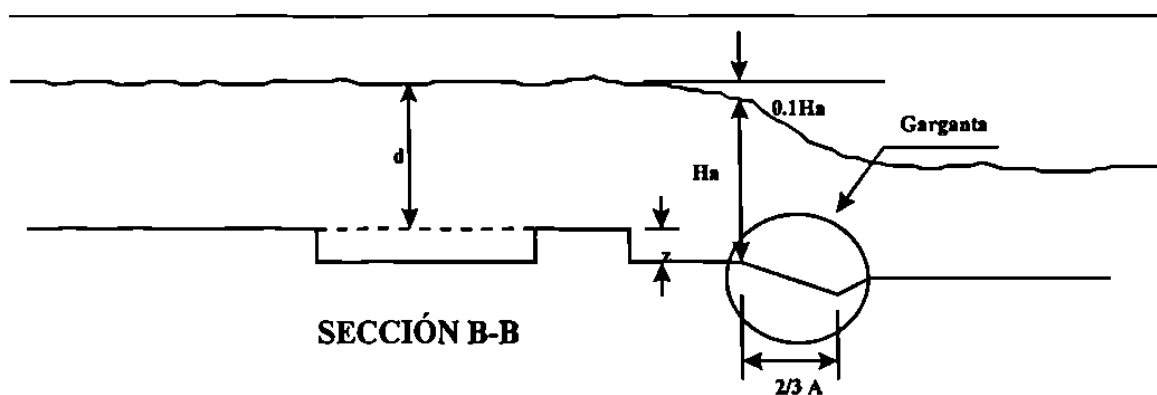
Sección longitudinal del Desarenador y del Canal Parshall, Sección B-B de Planta
